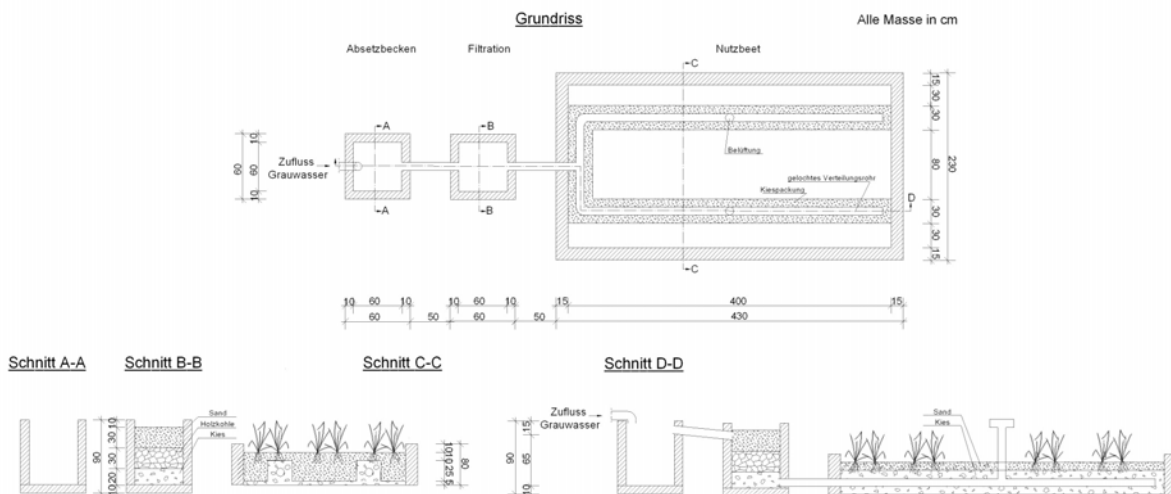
Plan et coupe montrant l'utilisation des eaux grises pour le jardinage ou maraîchage
